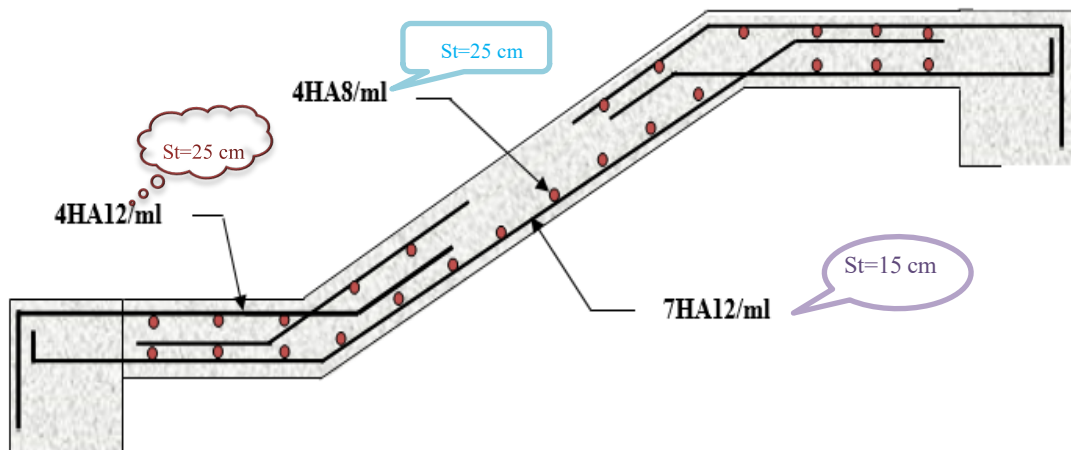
Schéma de ferrailage de la partie 1 de l'escalier
